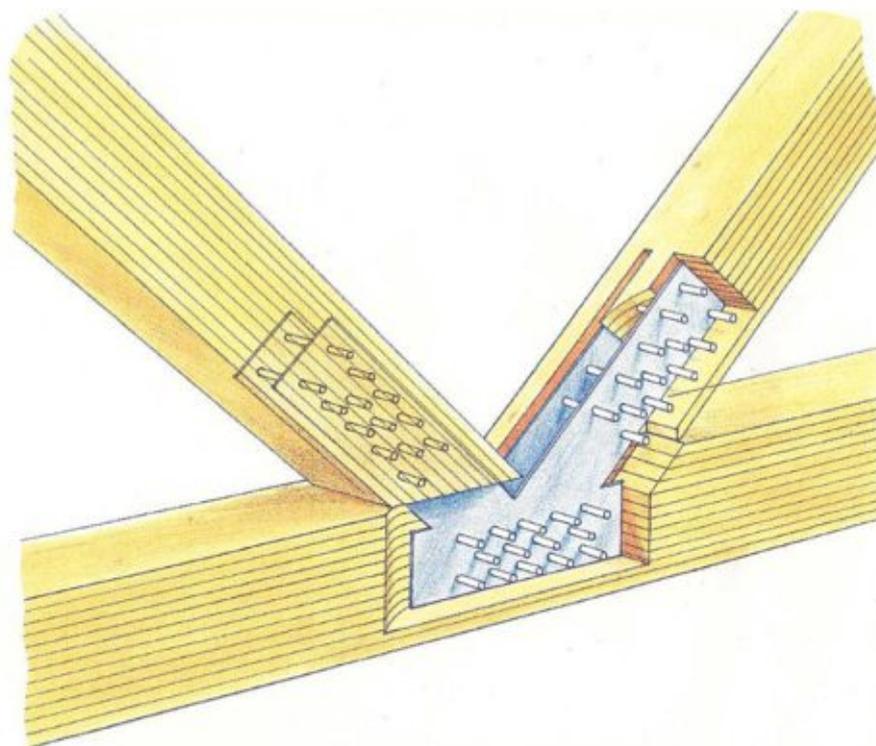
Verbindungsschema Haupttragwerk (eingelassene Stahlplatten)
